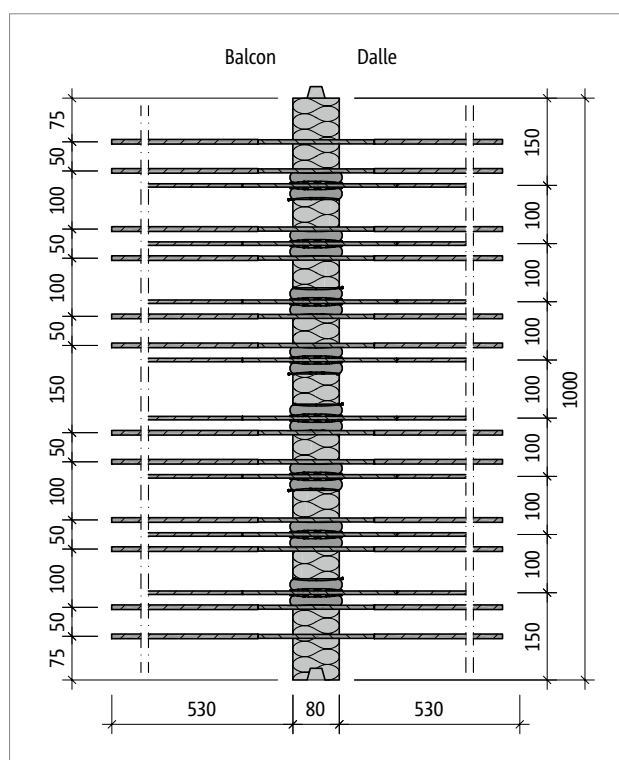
Schöck Rutherma® T type DBi-M1-V2 : vue en plan du produit
